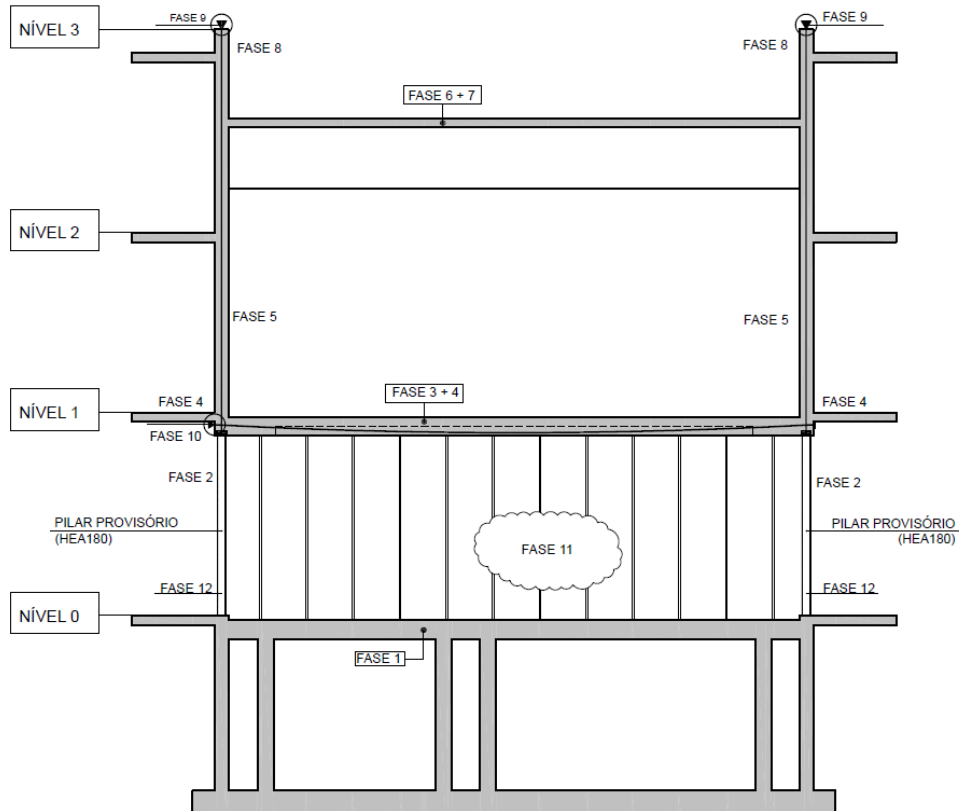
Faseamento construtivo da laje auditorio, viga-parede e da aplicação do pré-esforço.
